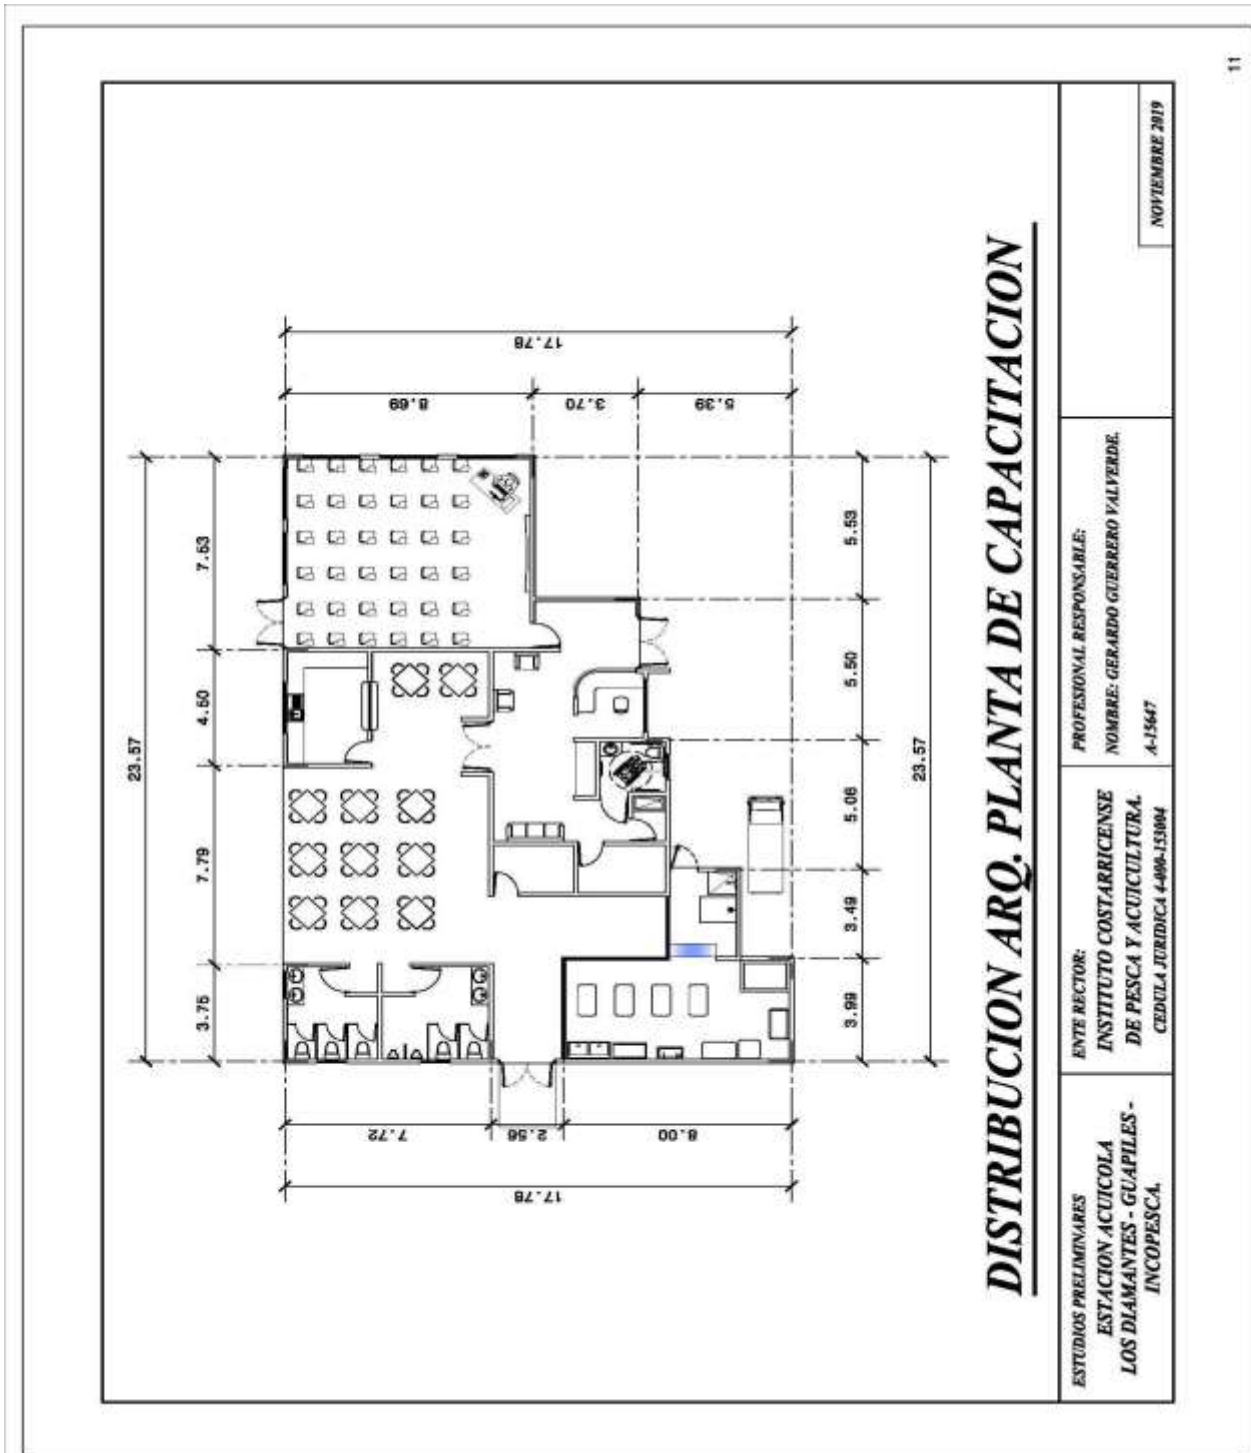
Distribución Arquitectónica de Planta de Capacitación
